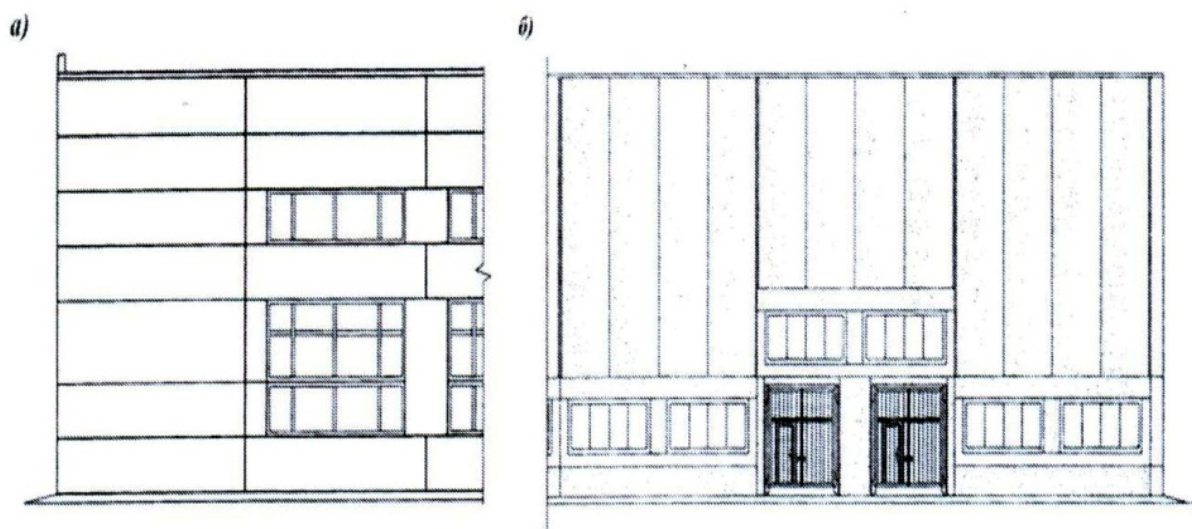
Варианты разрезки стен на панели одноэтажного промышленного здания:
